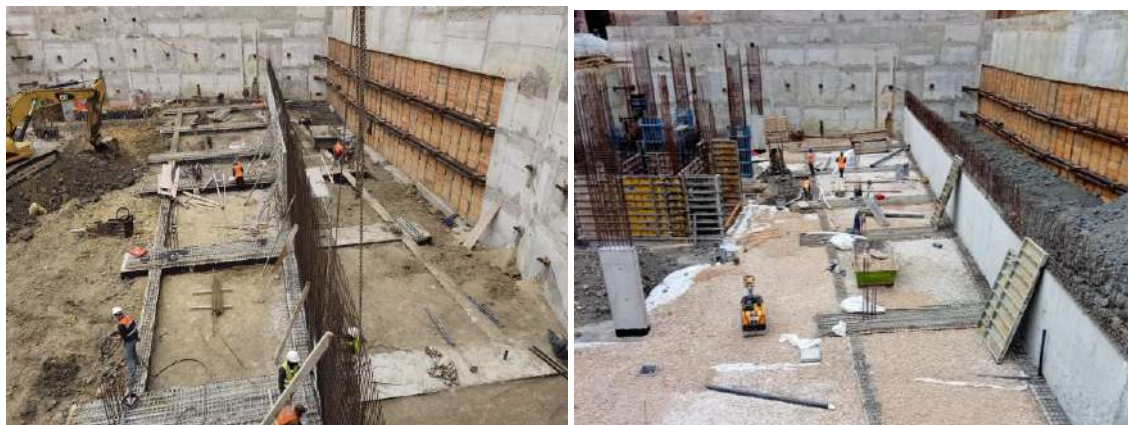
Execução dos pórticos de fundação sobre a galeria do ML.
